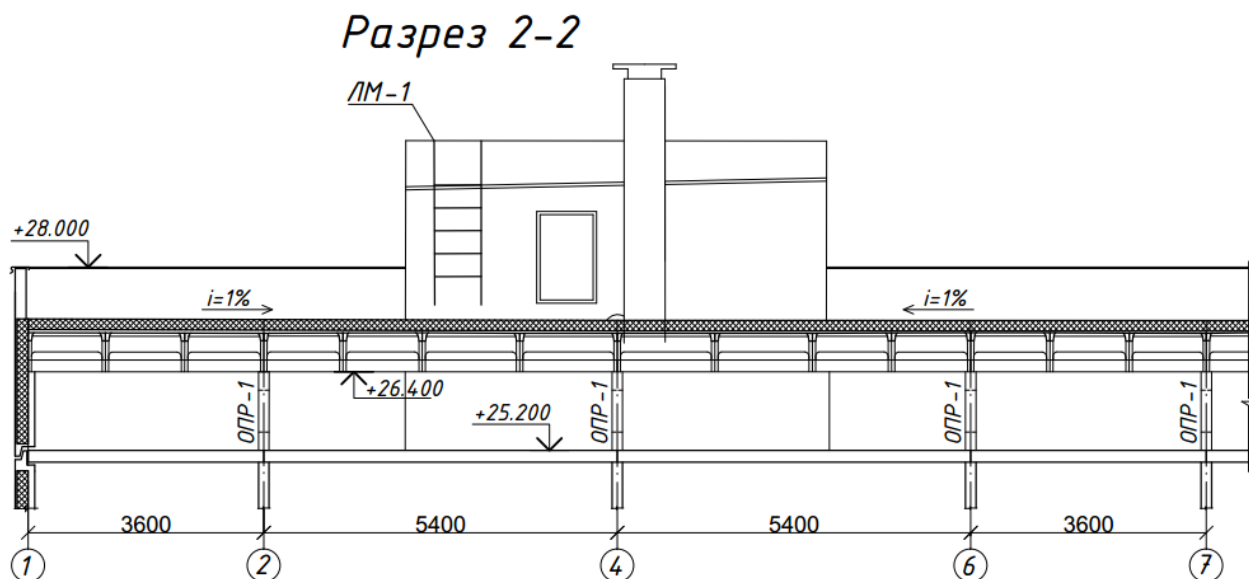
Теплый чердак и рулонная кровля. Продольный разрез
